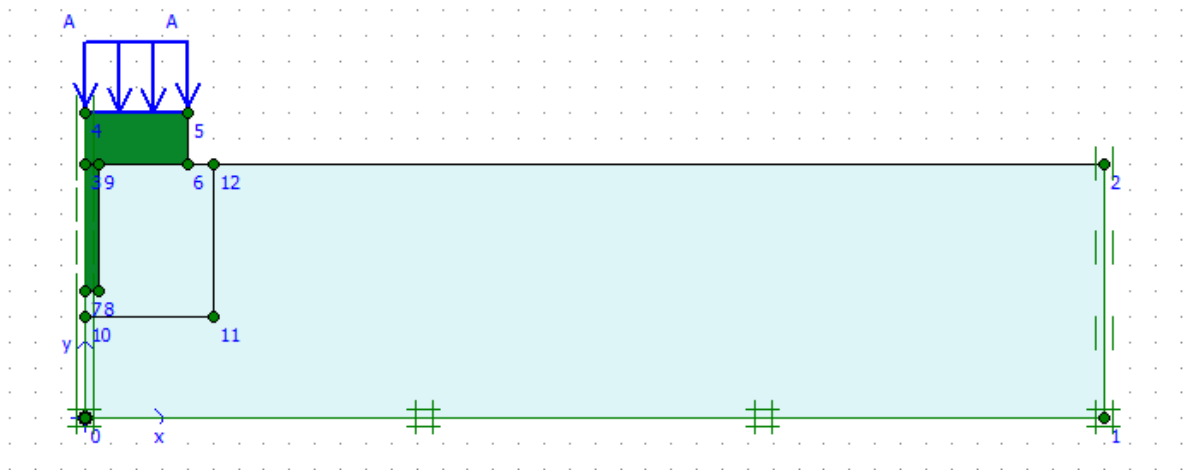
37: Dimensionnement en cas d'une semelle avec pieu de L=5m et D=1m.
